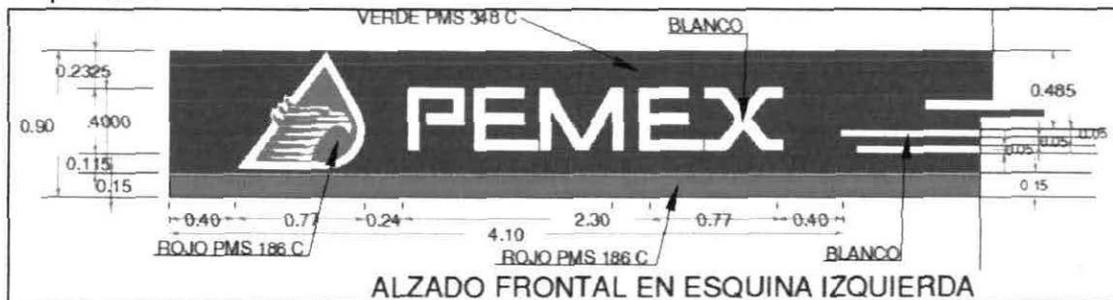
Faldón perimetral adosado a la techumbre, siguiendo los lineamientos y especificaciones de PEMEX.
